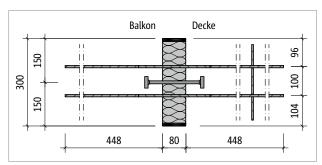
Schöck Isokorb® T Typ QP-V1: Produktgrundriss
